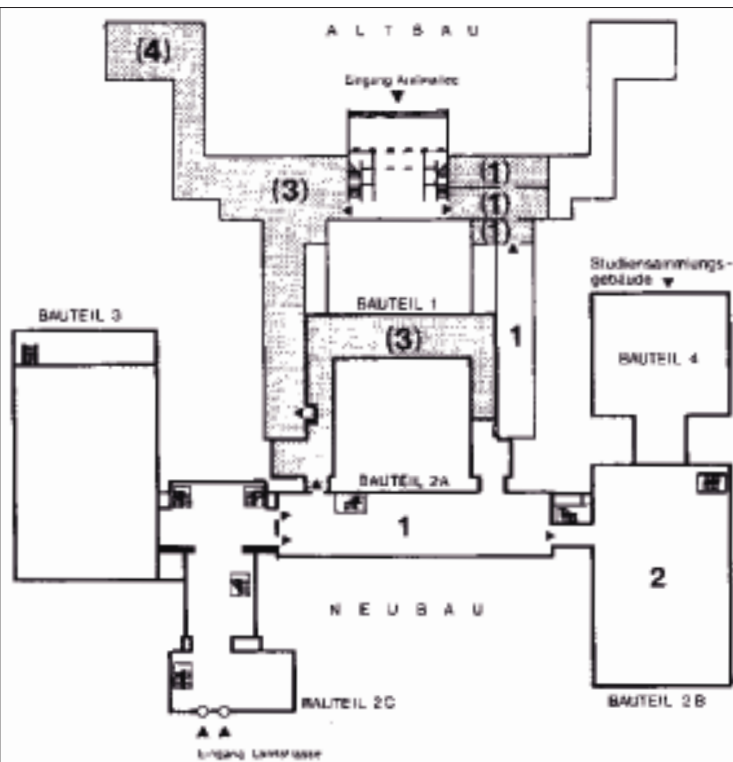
Grundriß der Museumsbauten in Dahlem. Ausstellungen im Erdgeschoß von Altbau und Neubauten:
